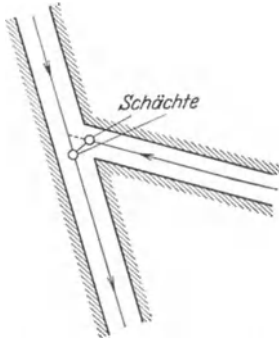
Schachtanordnung bei spitzwinkliger Einmündung zweier Leitungen.
